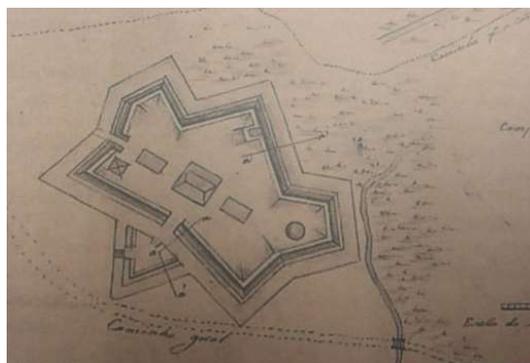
Antiga planta baixa do Forte do Raio. Fonte: DE MELLO (2018).
